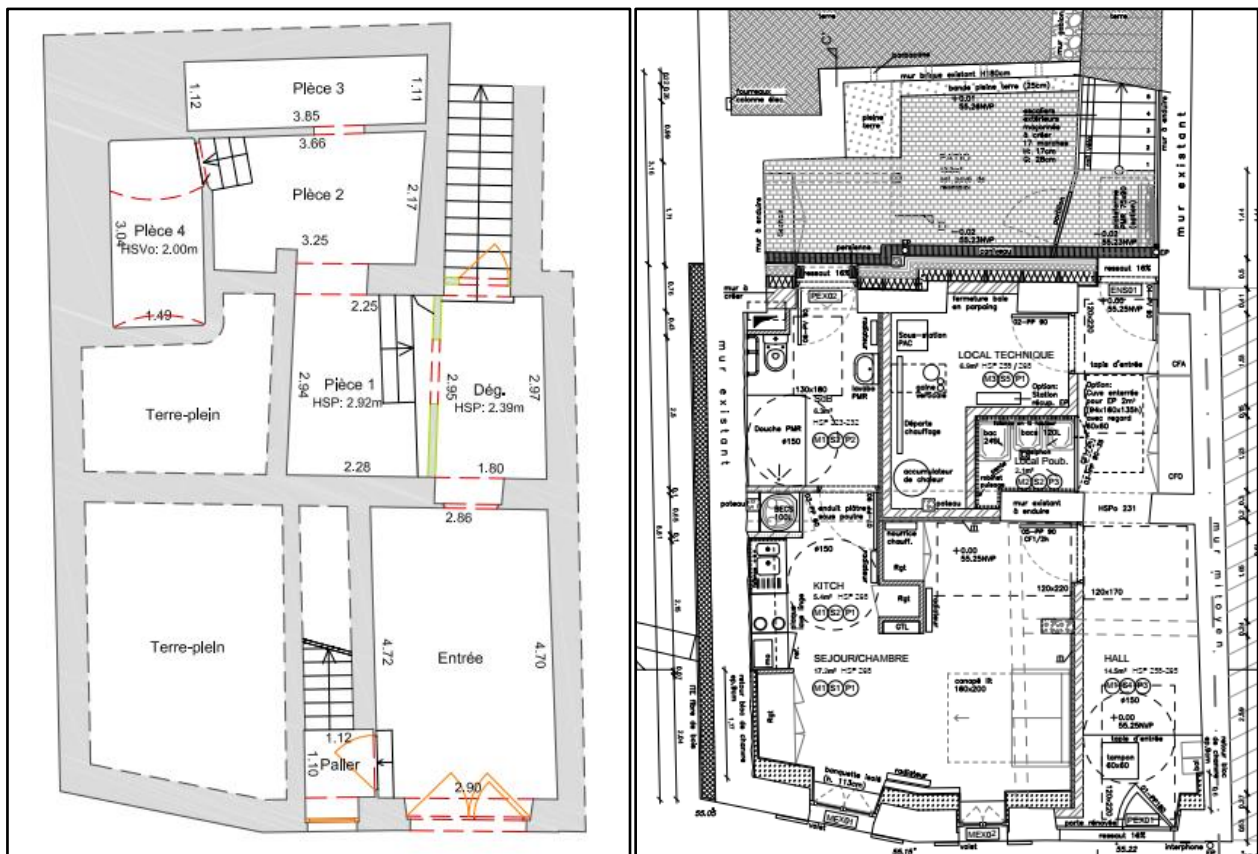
Plan du RDC, état existant à gauche et état projeté à droite
